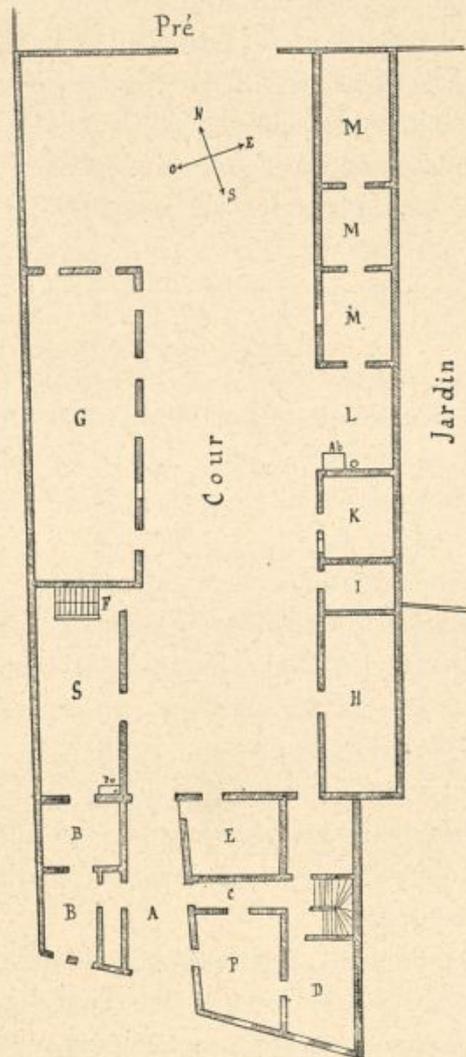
Plan du rez-de-chaussée de l'École de la Guillotière (1762).
